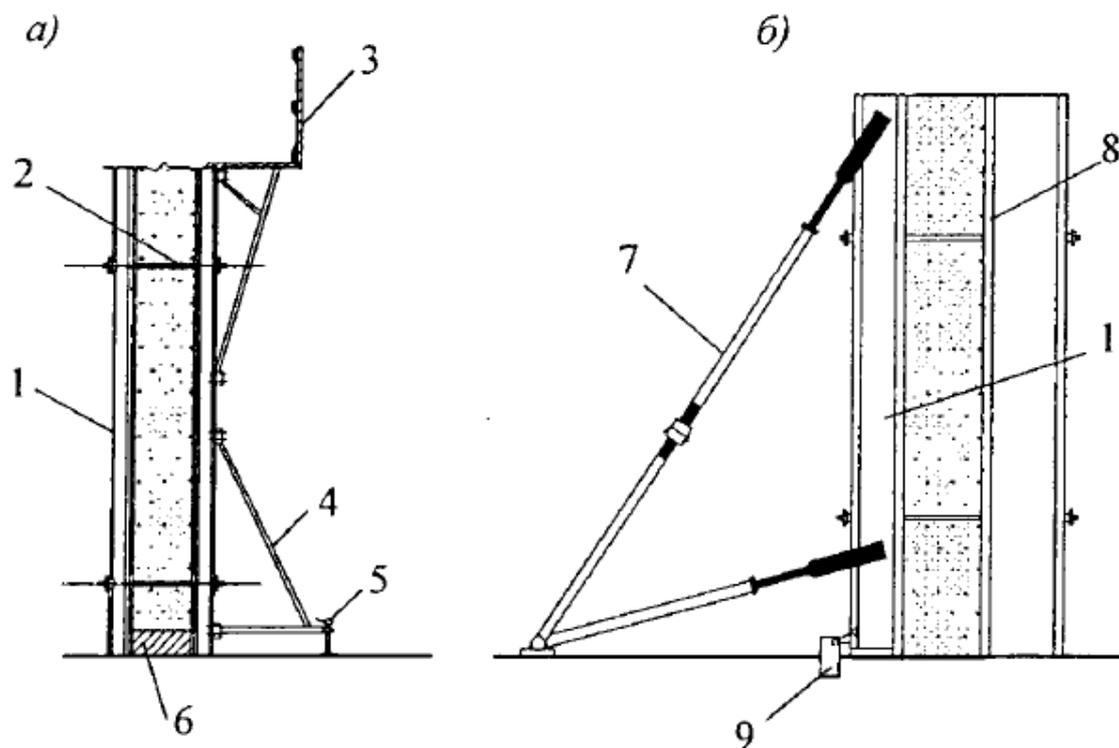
Крупнощитовая опалубка стен фирмы «Мева»:
